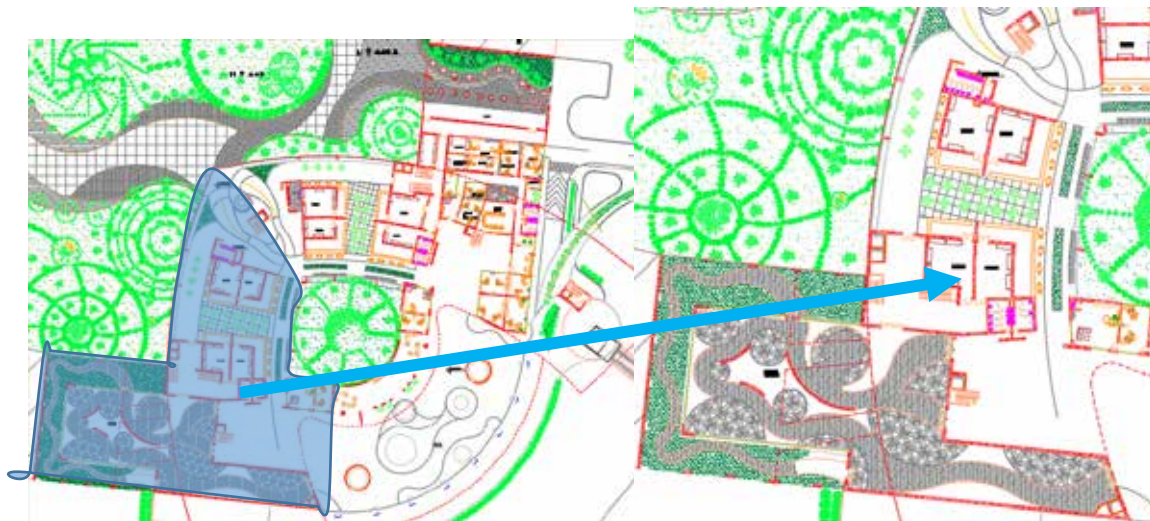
Plano Planta Baja +887.2m con zoom en el Ala "B". (2017).
